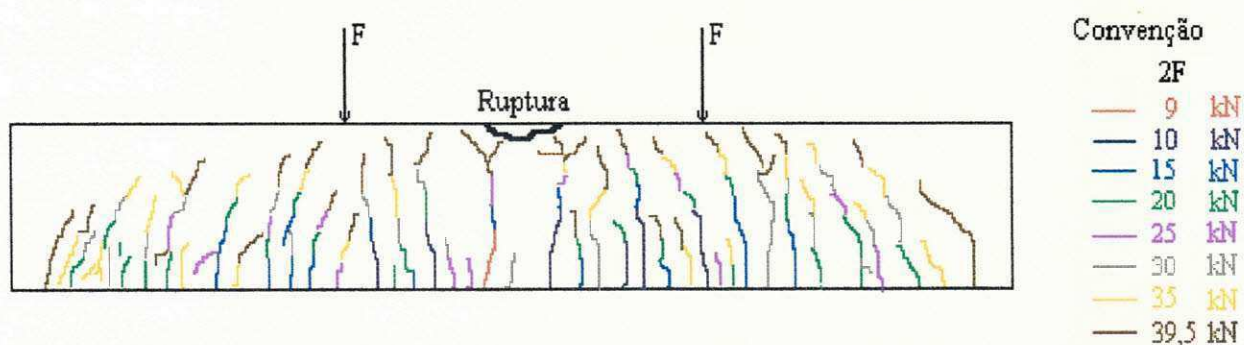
Evolução das Fissuras para a Viga VC-01
